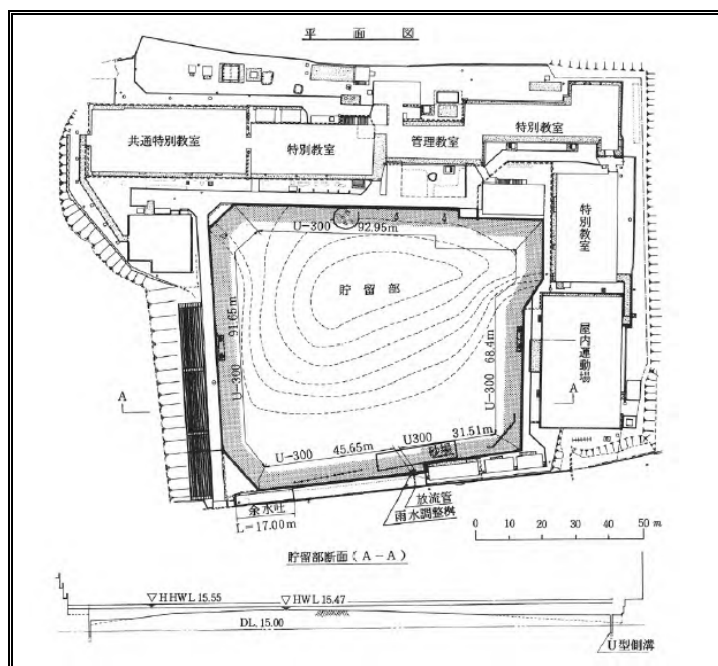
市川市立第 2 中學校滯洪設施位置平面圖
